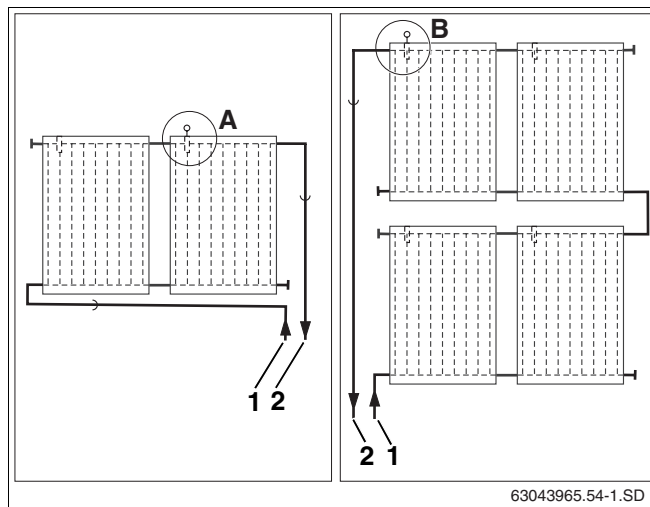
Posto d'installazione della sonda del collettore (rappresentazione schematica)
